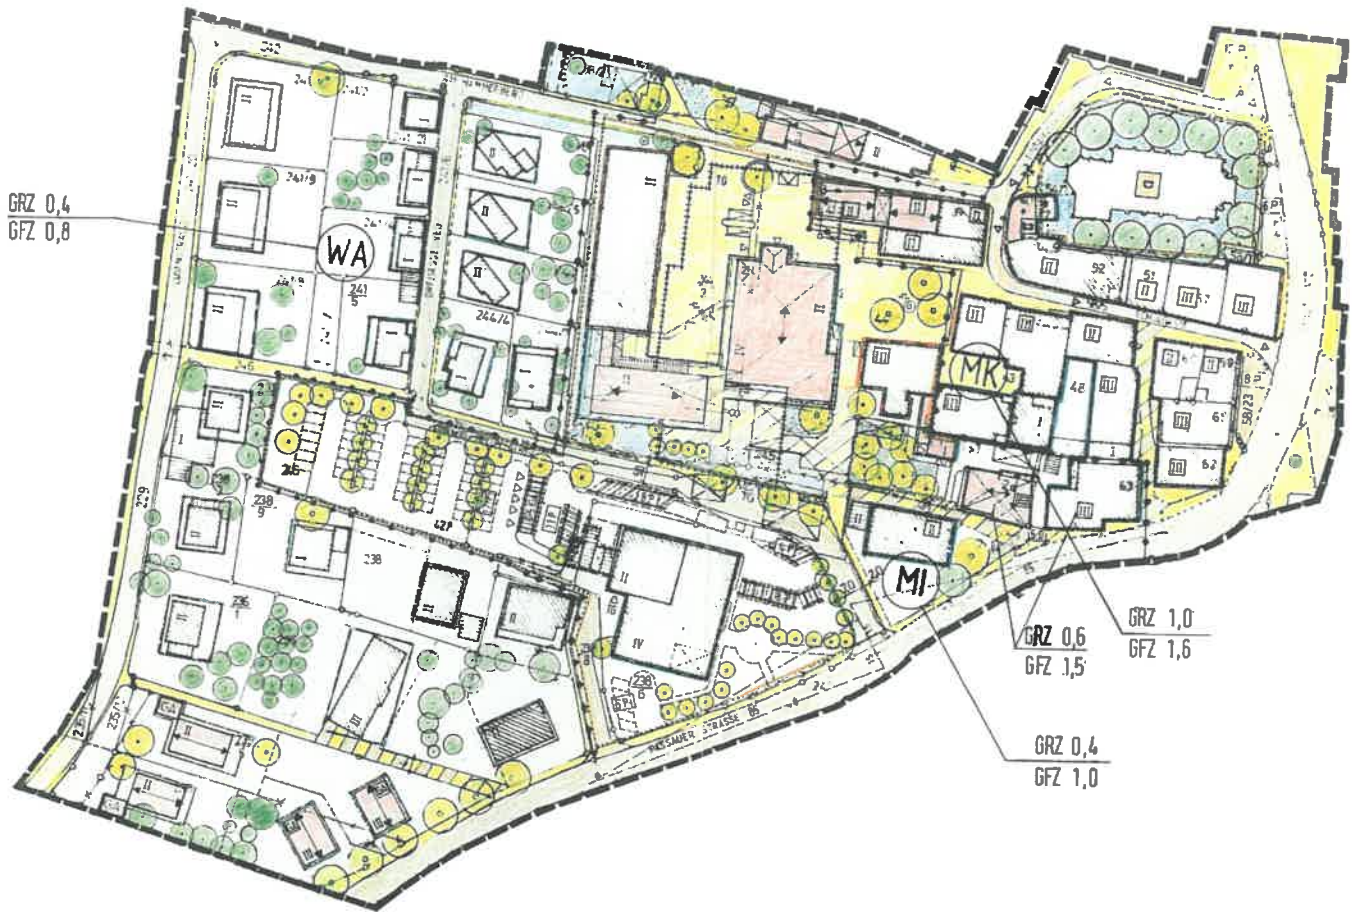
Bebauungsplan „Freyung-Stadtmitte“ mit Deckblättern 1 und 2 (ohne Maßstab)
